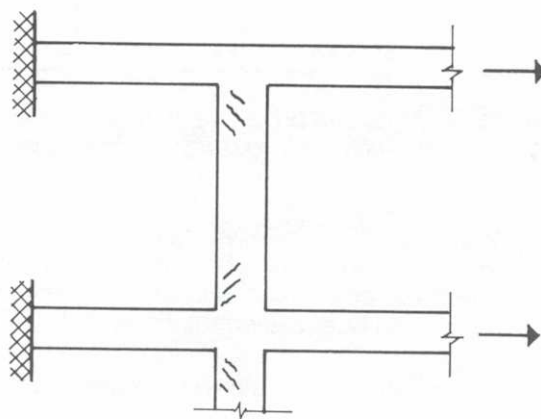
Pilar fissurado devido à movimentação térmica das vigas de concreto armado.
